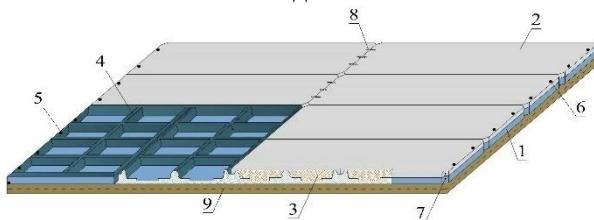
Сборная пространственная фундаментная платформа: 1- нижняя железобетонная ребристая плита; 2- верхняя железобетонная ребристая плита; 3- утеплитель; 4-ребра жесткости; 5-шпонки; 6-отверстия для шпонки; 7-выпуски арматуры в углах; 8-сварка закладных деталей; 9-скользящий слой.
